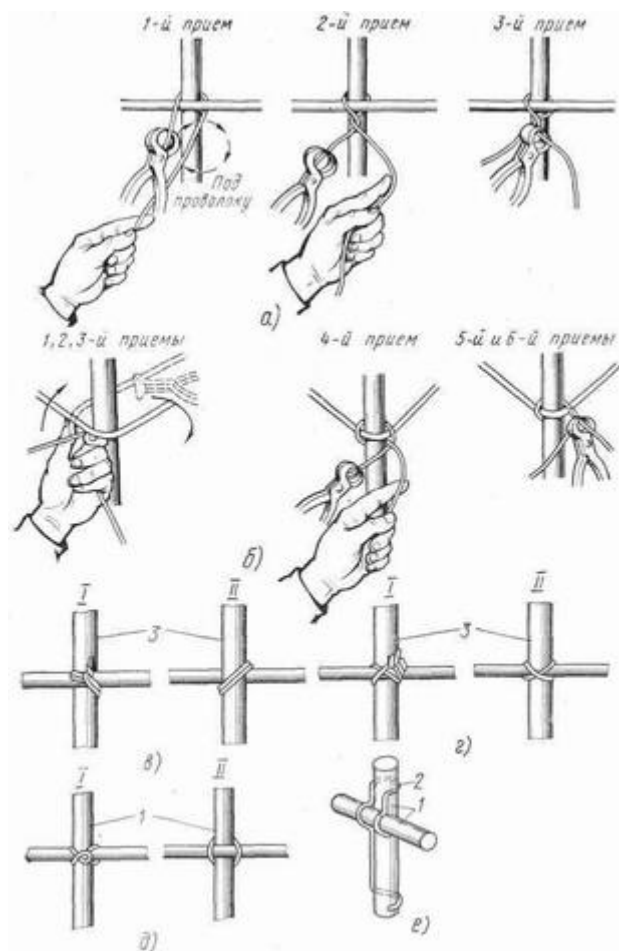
Вязка арматуры: а — вязка проволокой в пучках без подтягивания, б — вязка угловых узлов, в - двухрядный узел, г — крестовый узел, д — мертвый узел, е — скрепление стержней соединительным элементом; 1, 3 — стержни, 2 — соединительный элемент; I — вид спереди, II — вид сзади.
